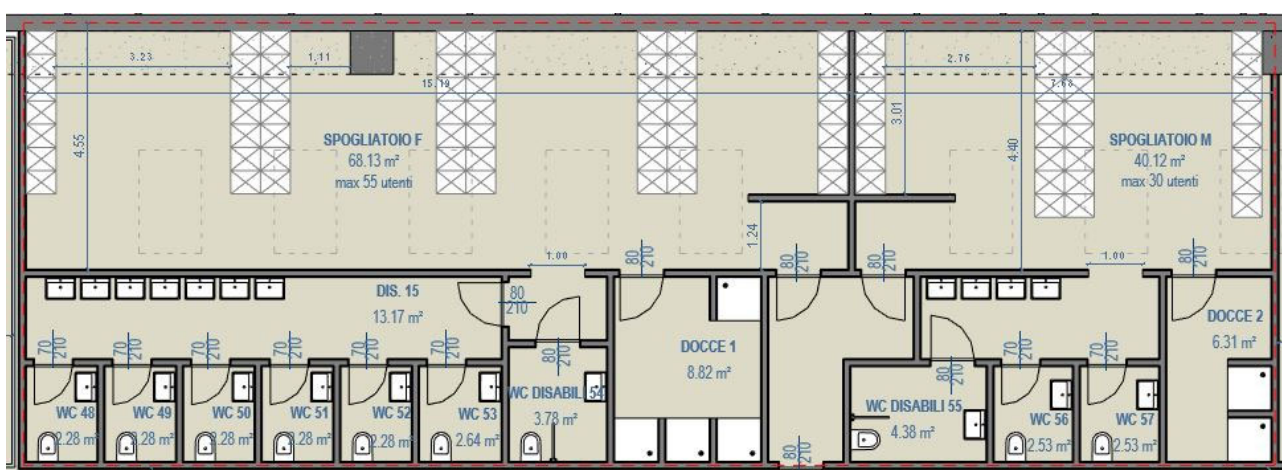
Estratto della planimetria dell'edificio di nuova costruzione
